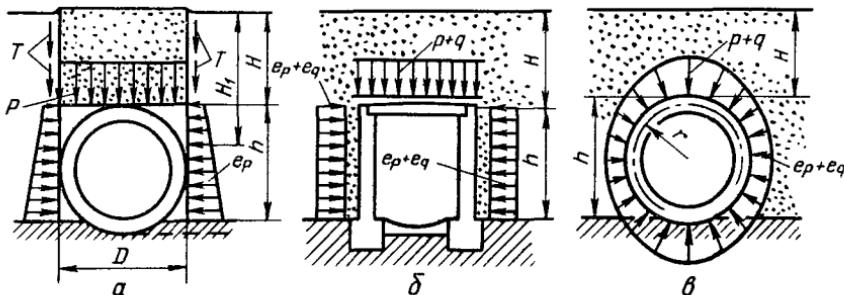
Схемы передачи давления грунта насыпи на трубы:
